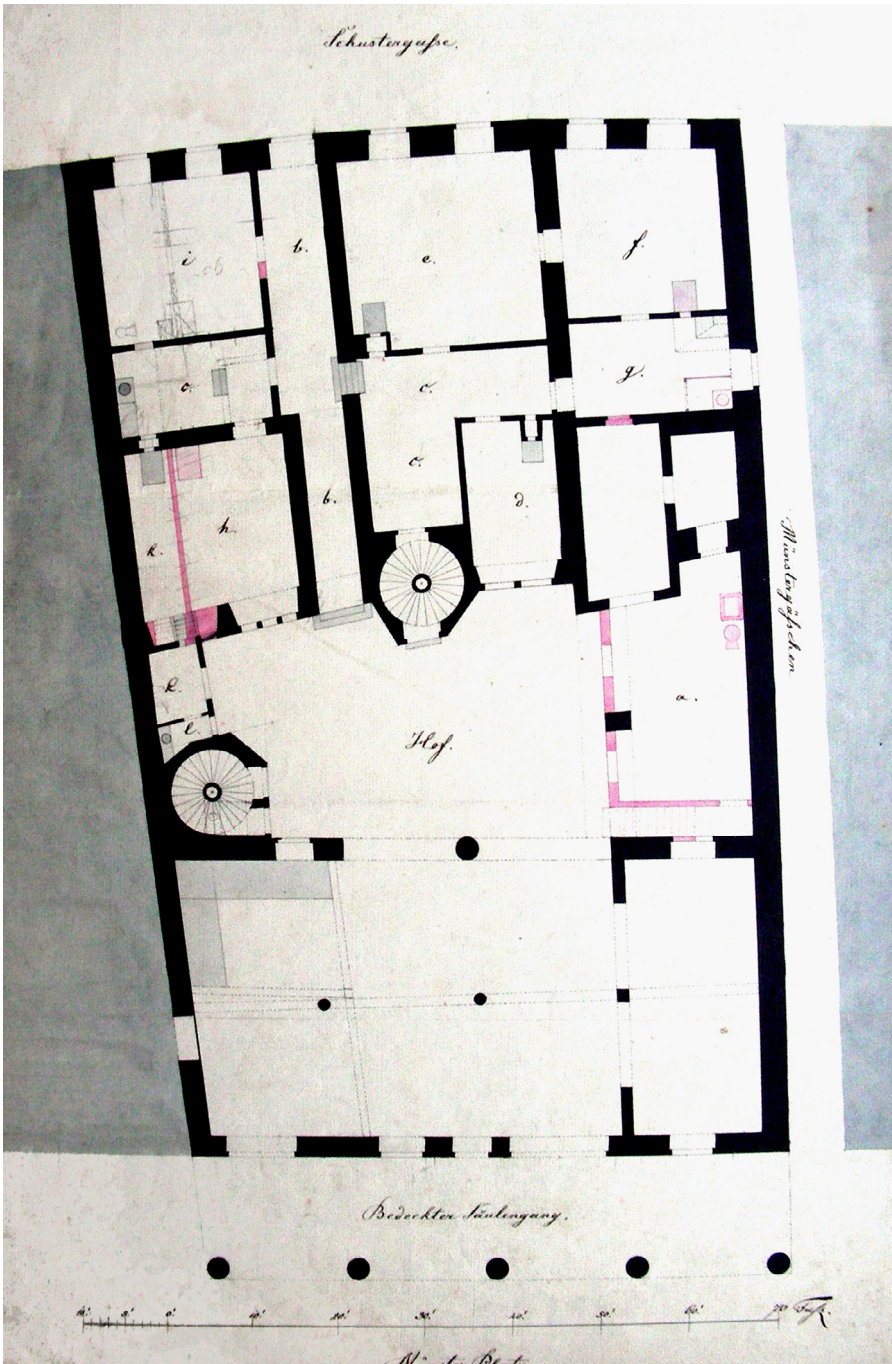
Historisches Kaufhaus, Grundriss des Erdgeschosses mit Altbau an der Schusterstraße (oben), Innenhof und Neubau am Münsterplatz. Plan: Mitte 19. Jahrhundert (Süden oben), Münsterbauhütte Freiburg.
